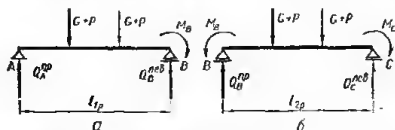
Расчетные схемы для определения поперечных сил в главной балке.
